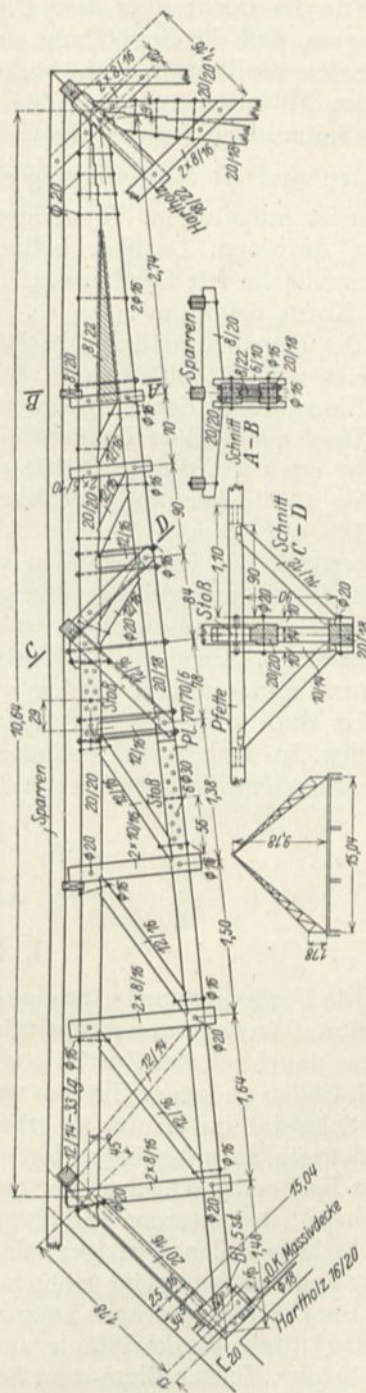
Pferdestallgebäude Baudach. Ausbildung der hölzernen Dachkonstruktion.
